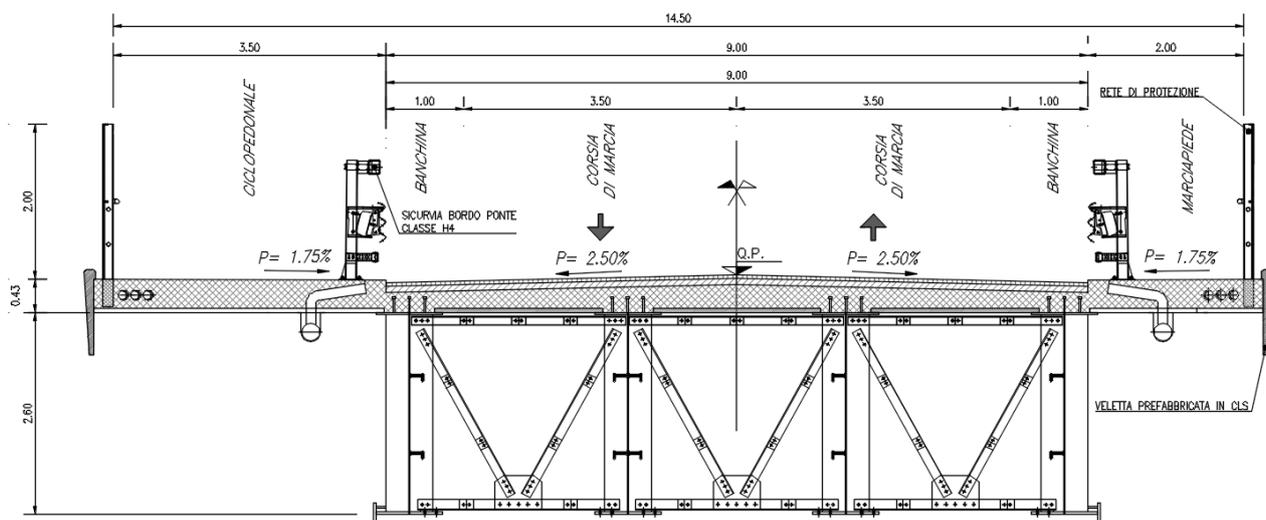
Sezione tipo di Progetto - cavalcaferrovia IV26 (L=55,00 m)
